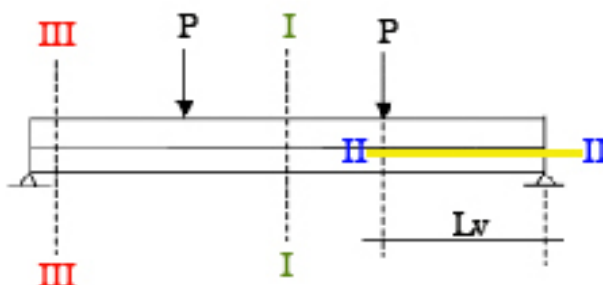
Modos de colapso no estado limite último da laje mista aço-concreto
